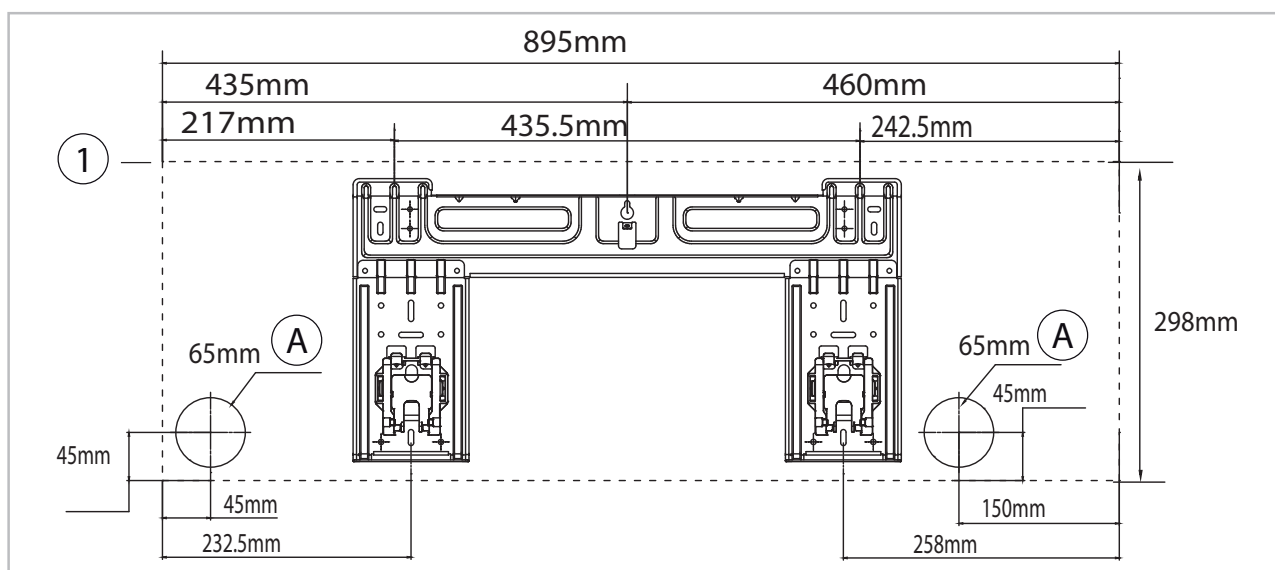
Points de montage du support mural RVT 265-355 DC (vue arrière)
